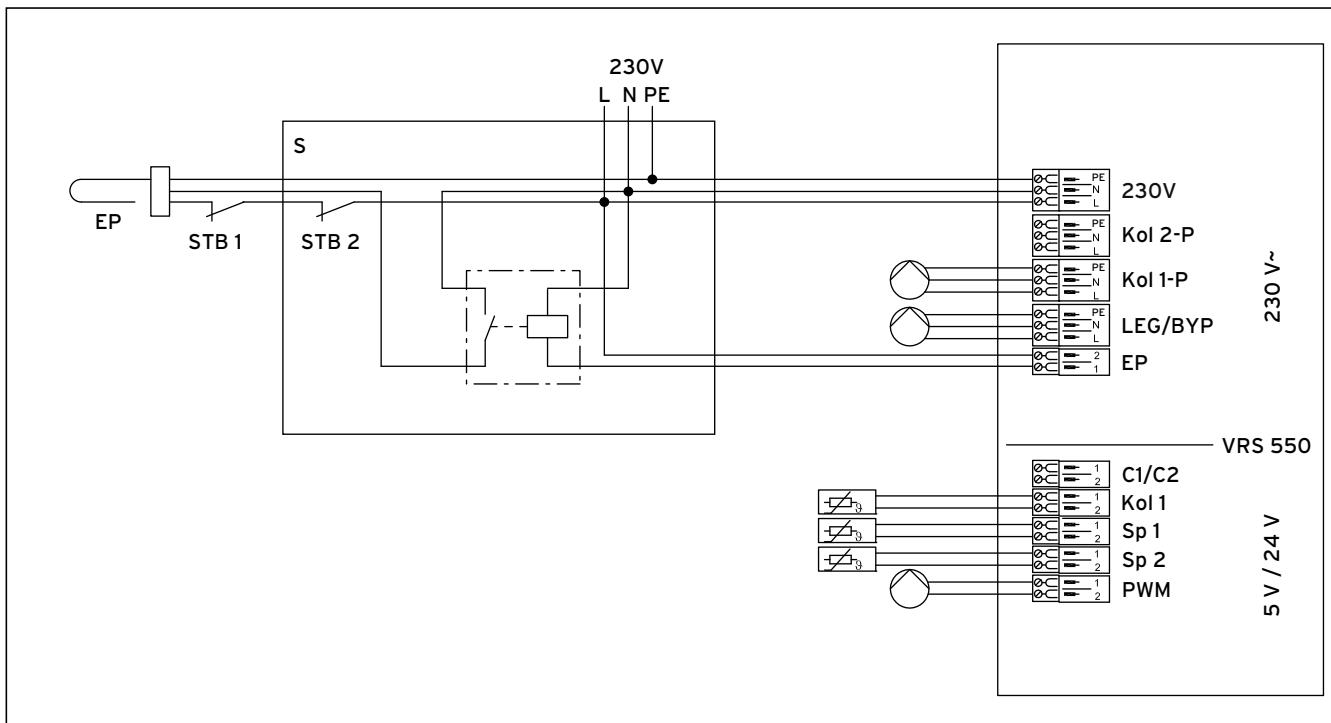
Anschlussplan für Hydraulikplan 2
